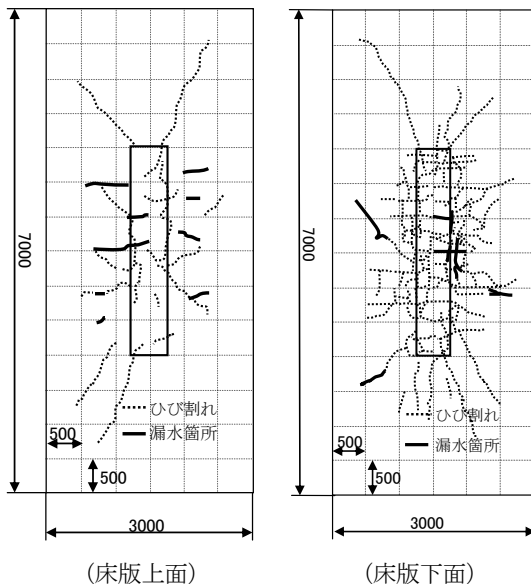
床版ひび割れ状態(E 予備載荷後)
